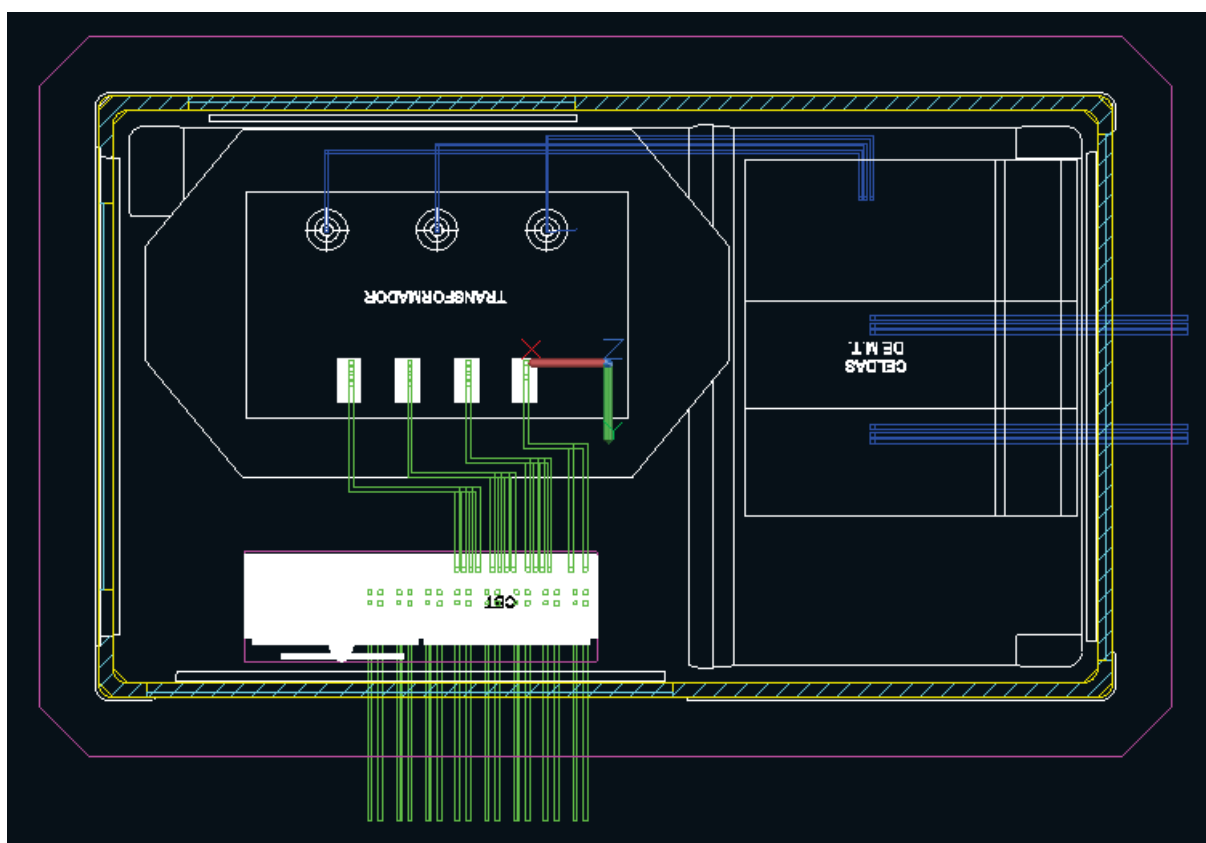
Vista en planta de la instalación (2L+1T [Semi]) (cotas en mm).
